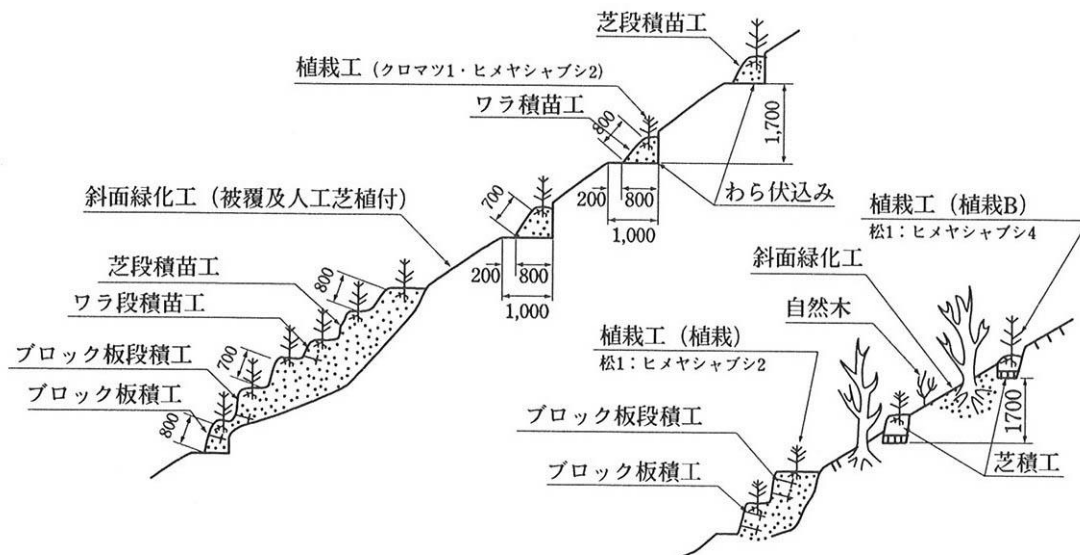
積苗工を主とした山腹工（施工例）断面図
